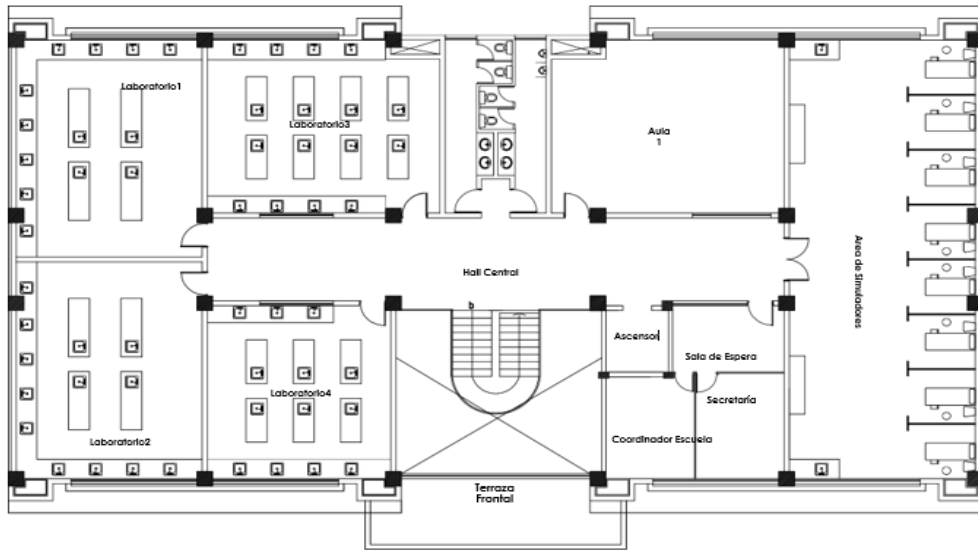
Planos de Infraestructura Segundo Piso Laboratorio
